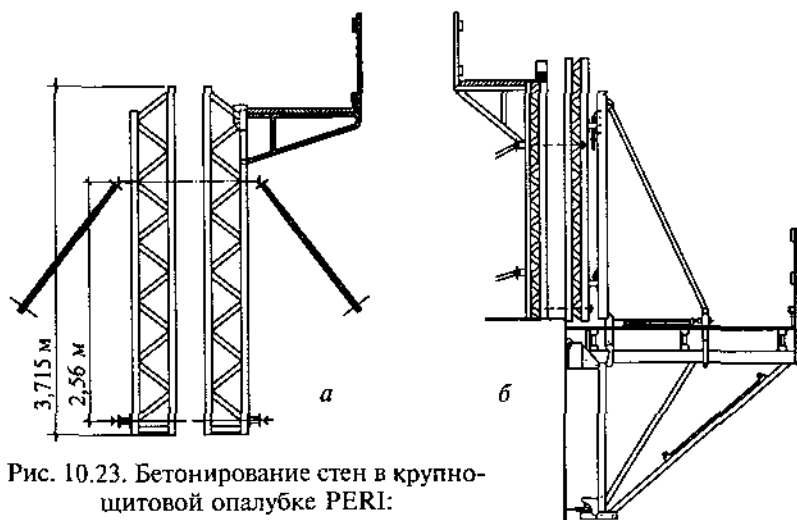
Бетонирование стен в крупно-щитовой опалубке PERI:
